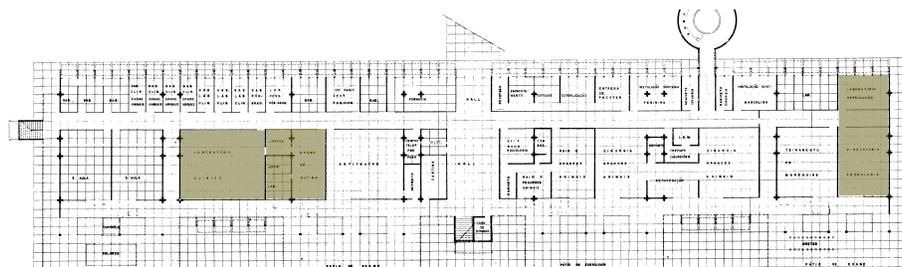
Planta de localização -laboratórios do pavimento térreo
